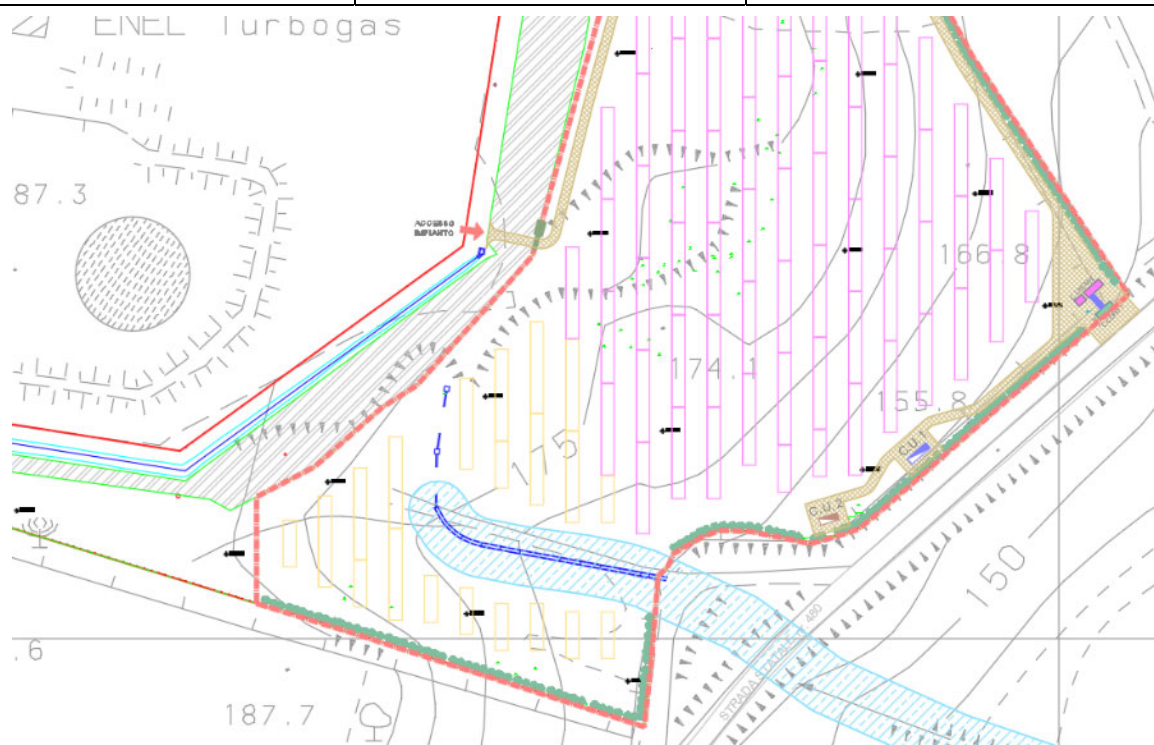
stralcio planimetria di layout di impianto con particolare reticolo e fascia di rispetto (linea blu e retino ciano) non interferenti con le strutture fv
